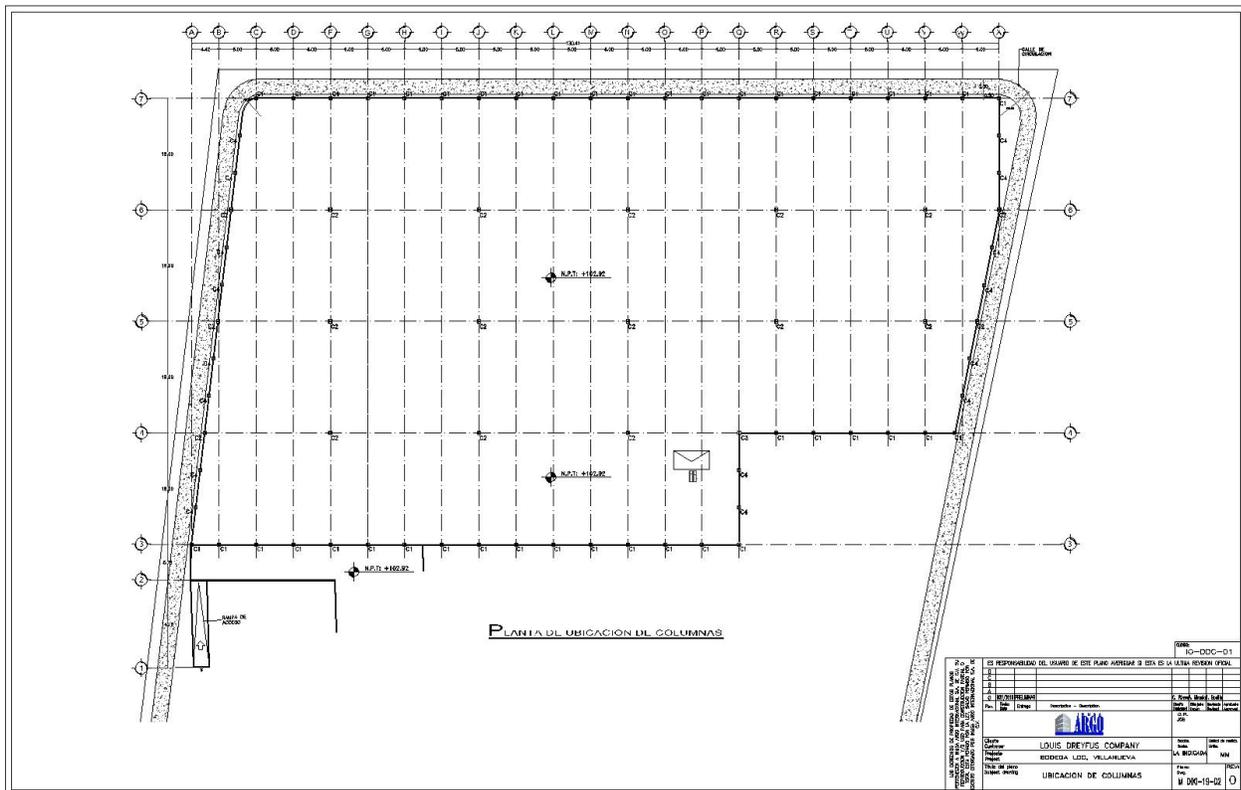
Planta de ubicación de columnas, nave de almacenamiento, LDC
